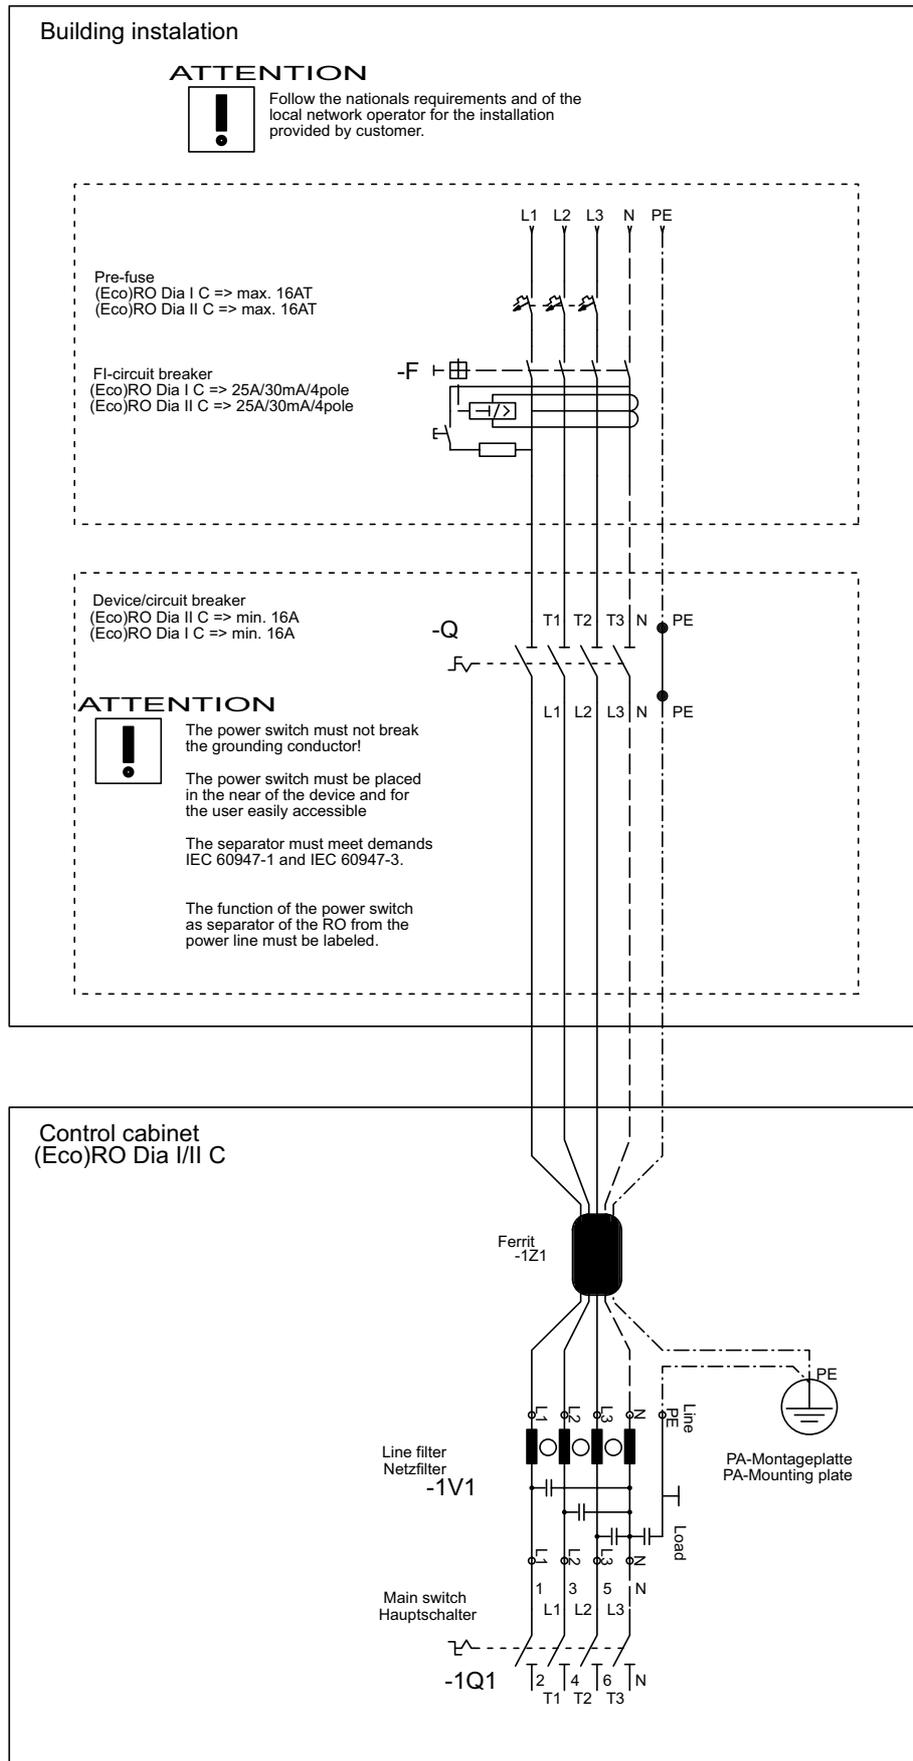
Plan de mise en place (Eco)RO Dia II C
